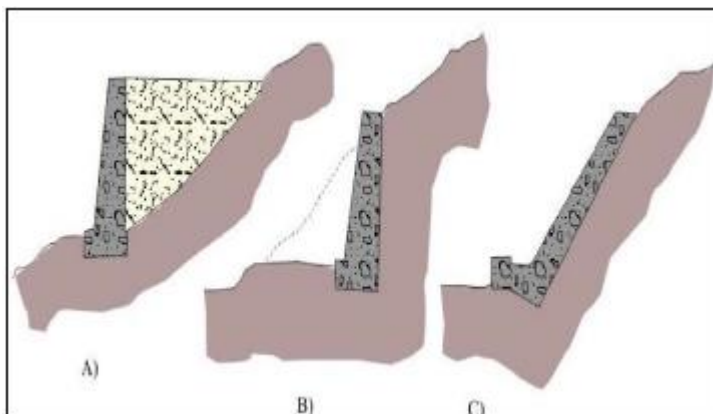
a) Muro de sostenimiento b) Muro de contención
